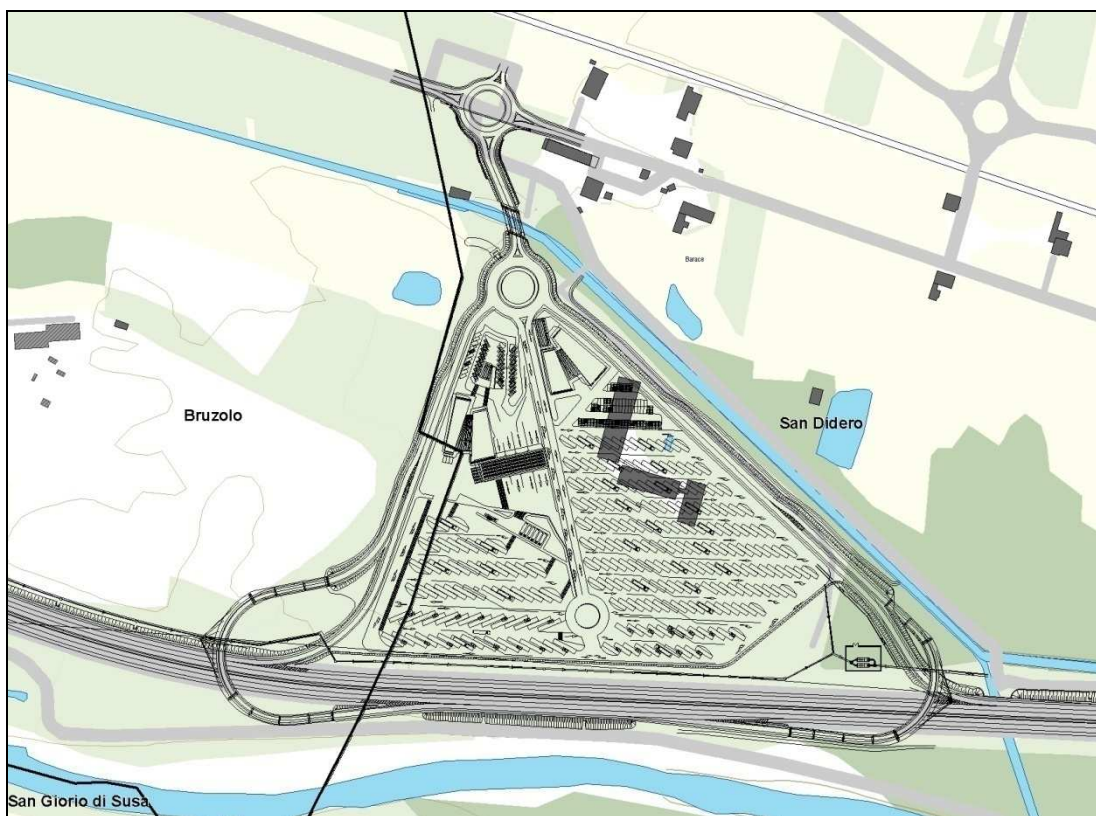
Planimetria schematica con ubicazione dell'ipotesi progettuale prescelta
